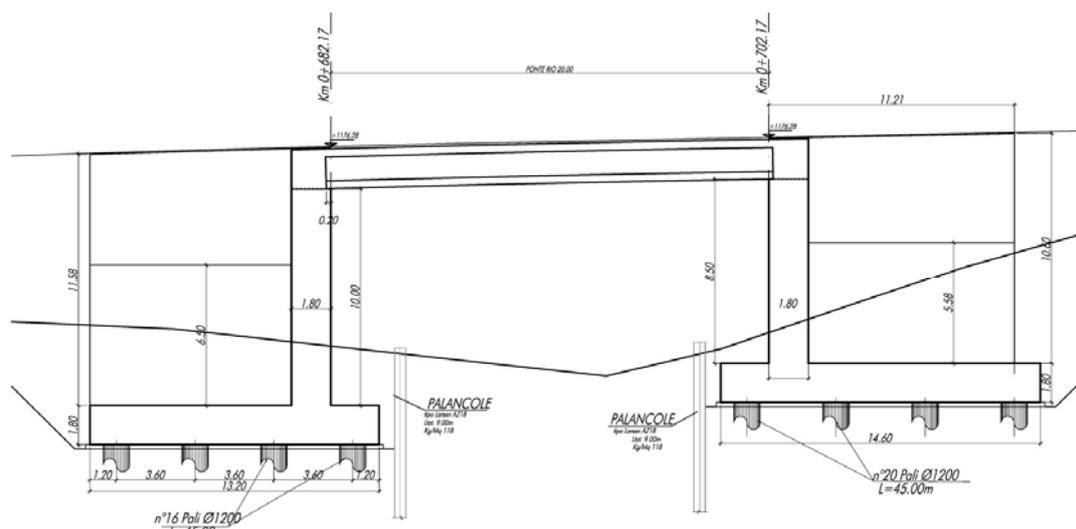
Sezione Longitudinale del Ponte Ries (ns. elaborazione da tavola T01VI03STRDI01_A_Pianta impalcato, sezione longitudinale e dettagli del progetto definitivo).
